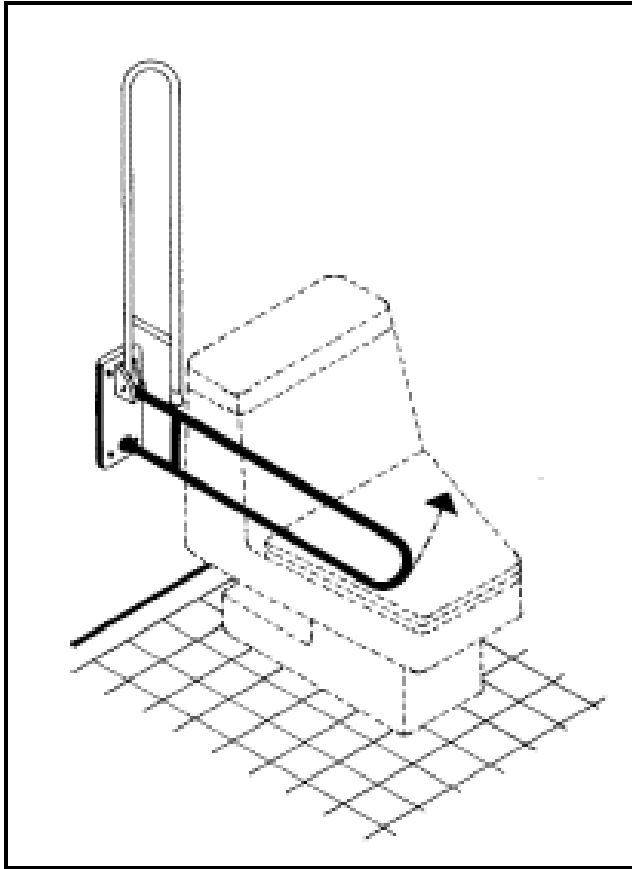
L'utilisateur peut se servir des barres d'appui situées d'un côté ou de l'autre (ou des deux côtés) du cabinet de toilette. Un dispositif d'appel devrait être installé près du cabinet de toilette au cas où l'utilisateur aurait besoin d'aide. (Voir aussi la Figure 32, p. 66.)
